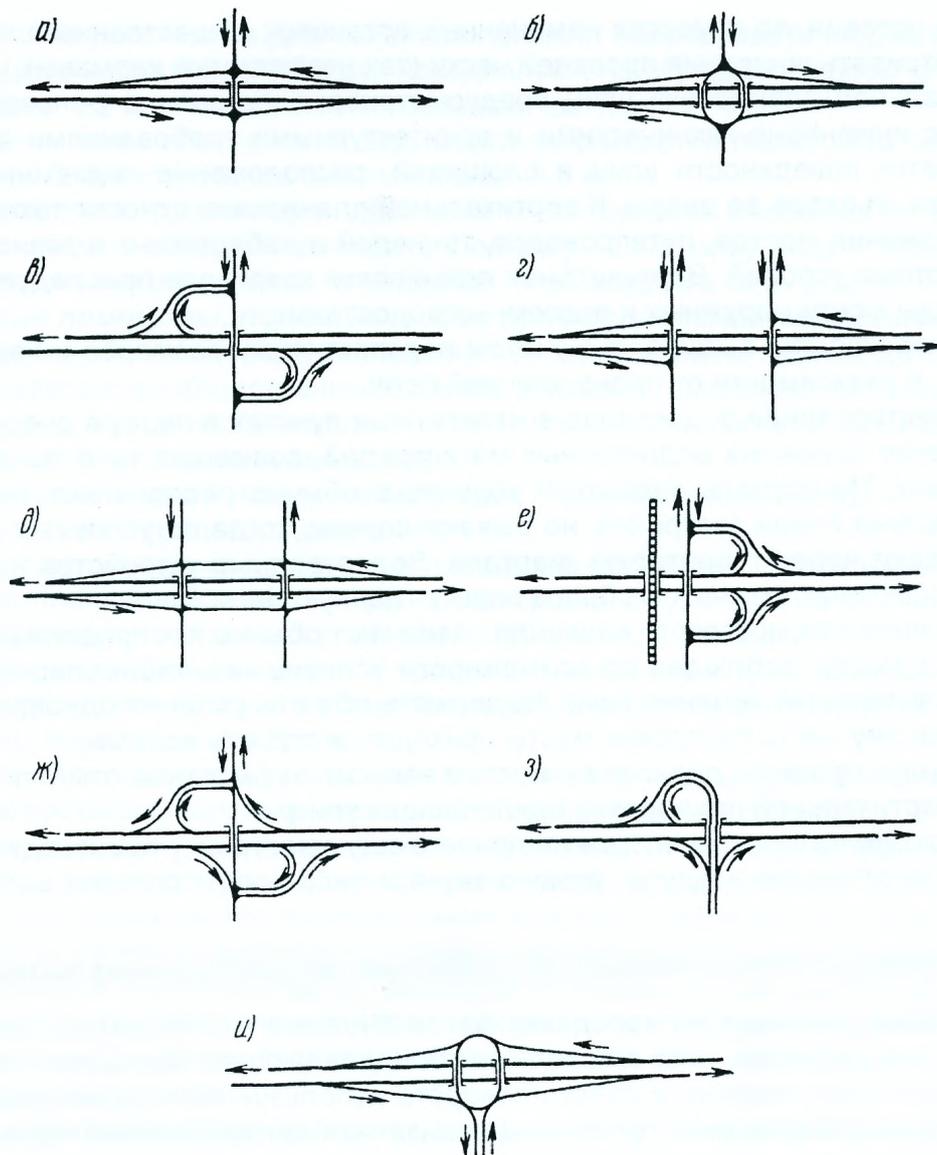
Основные схемы пересечений городских автомобильных магистралей в разных уровнях: а – пересечения по типу ромба; б – ромб с распределительными кольцами; в – неполный клеверный лист; г – разрезанный ромб; д – разрезанный ромб с соединительными путями; е – неполный клеверный лист при невозможности проложения съездов вдоль магистрали; ж – неполный клеверный лист с дополнительными съездами для устранения левых поворотов на пересекающей дороге; з – примыкание по типу трубы; и – примыкание с распределительным кольцом
